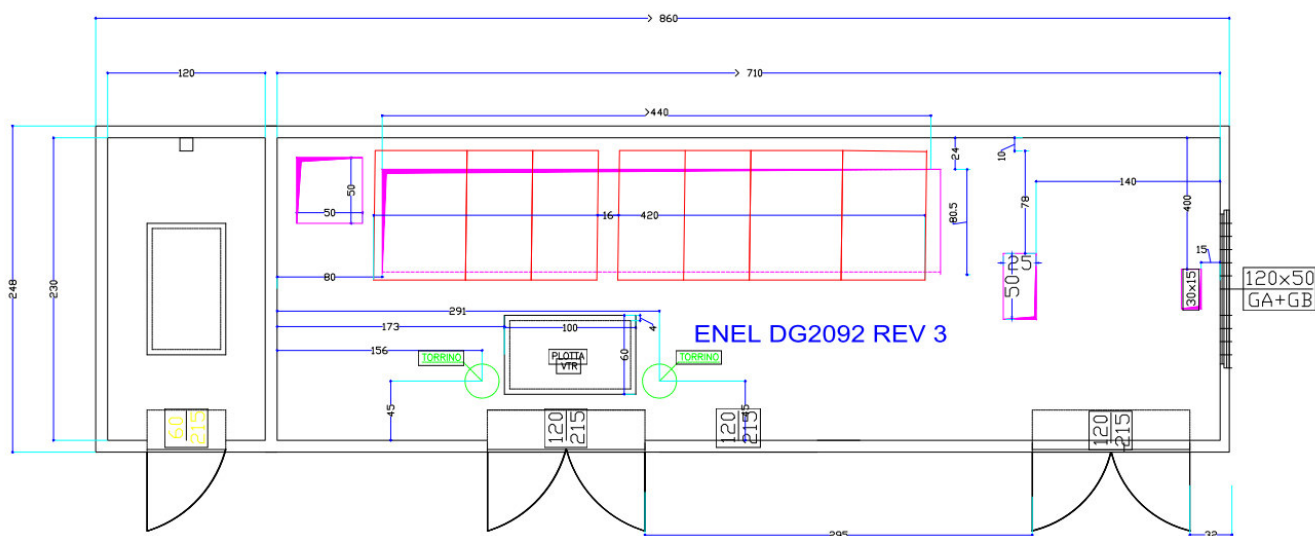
planimetria cabina di consegna di e-Distribuzione
